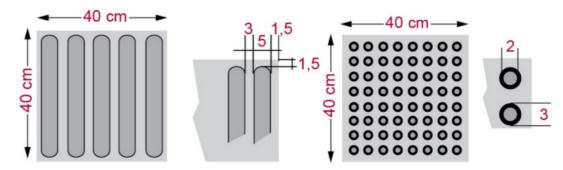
Pavimento guía de avance seguro y pavimento de alerta, respectivamente- MINVU. FUENTE: Ciudad Accesible, 2021
